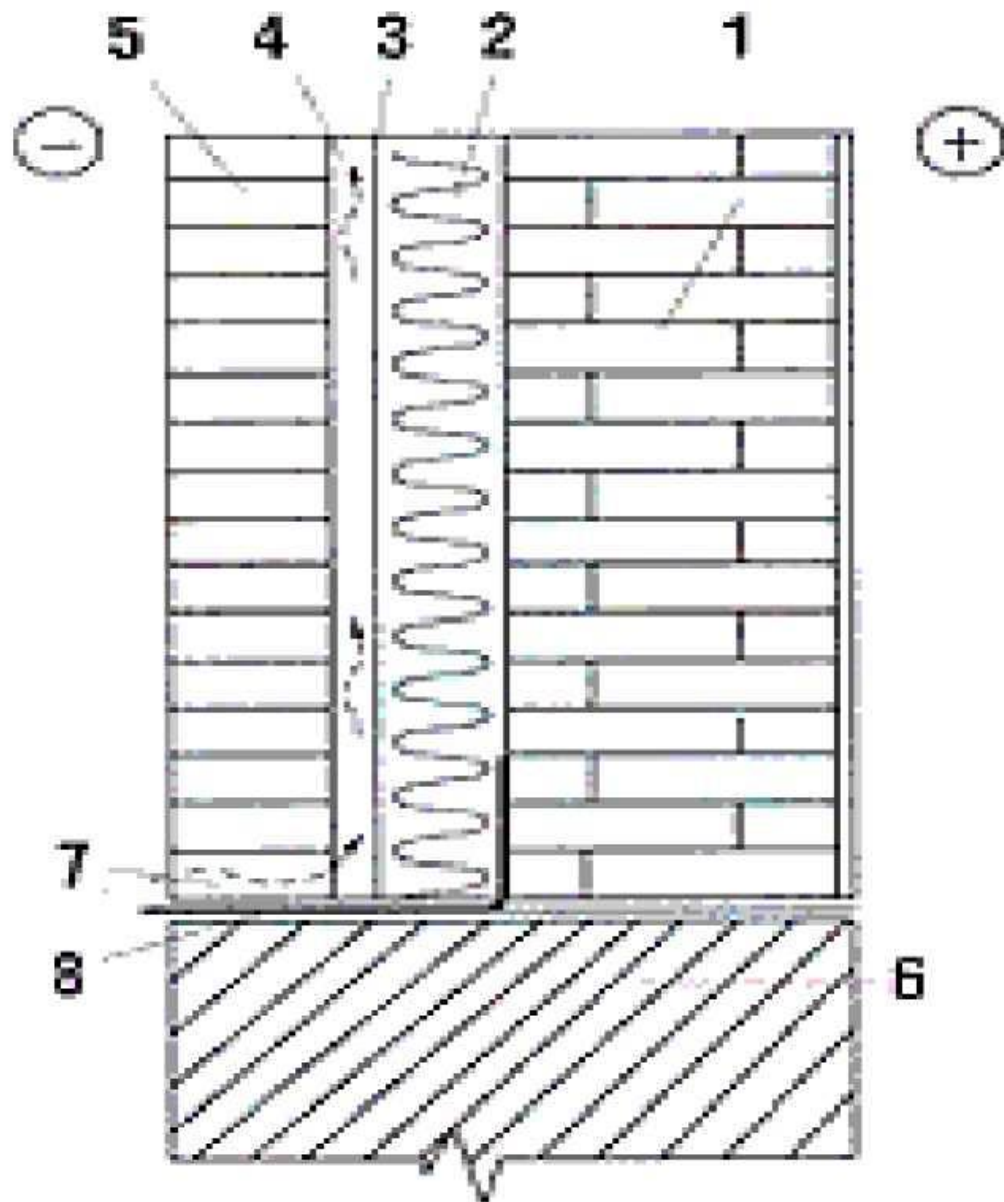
Фрагмент фасаду при облицюванні будівлі цеглою: 1- стіна, що утеплюється; 2 - утеплювач; 3- вітрозахисна паропроникна мембрана; 4- повітряний прошарок; 5 - облицювання з цегли та каменю; 6- фундамент; 7- вентиляційний продух; 8- гідроізоляційний матеріал Системи утеплення із захисно-декоративними екранами існують як в імпортному («Eternit» - Бельгія, LTM Company OY - Фінляндія, SLAVONIA (SPIDI), EUROFOX - Австрія та ін.).
